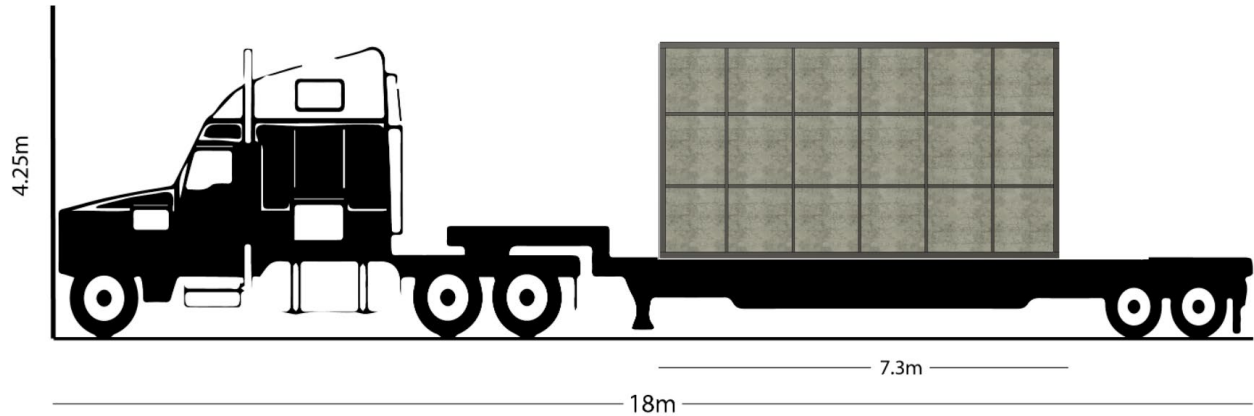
Diagrama de transporte de módulos del mueble habitable, sobre una cama baja. Elaboración propia.
